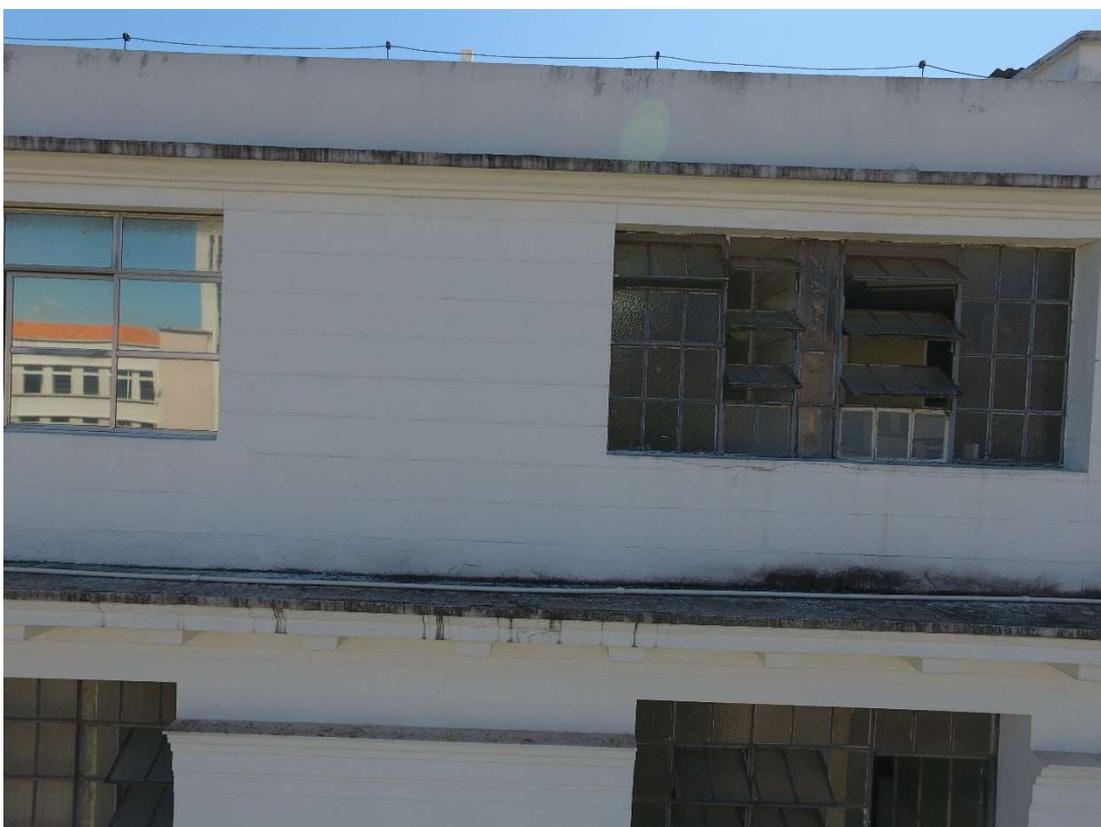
FOTO AÉREA - Fachada Interna (Av. Rodrigues Alves) SUPRIO com umidade nos beirais e na platibanda (Causa: falta de manutenção e limpeza da fachada / Solução: realizar reforma da fachada)
